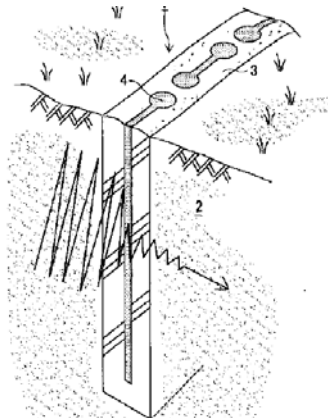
Ilmatyynyistä ja kumista valmistettu eristelevy, joka on sijoitettu kahden betonisseinän väliin.
